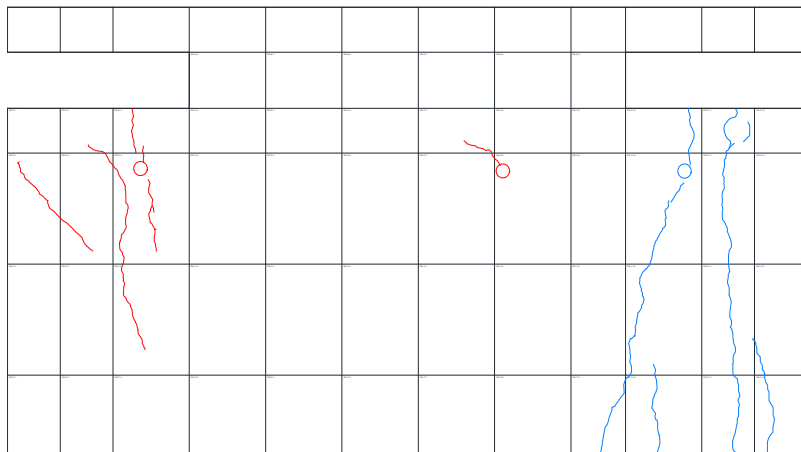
載荷終了時点のひび割れ スラブのひび割れ
